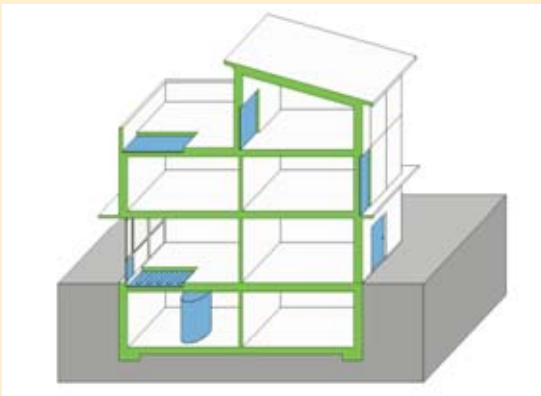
Einsatzgebiete (blau) sind beispielsweise Fassade (innen und außen), Brüstungen, Fußböden, Decken, Dachterrassen oder Loggien. Quelle: FHNW
